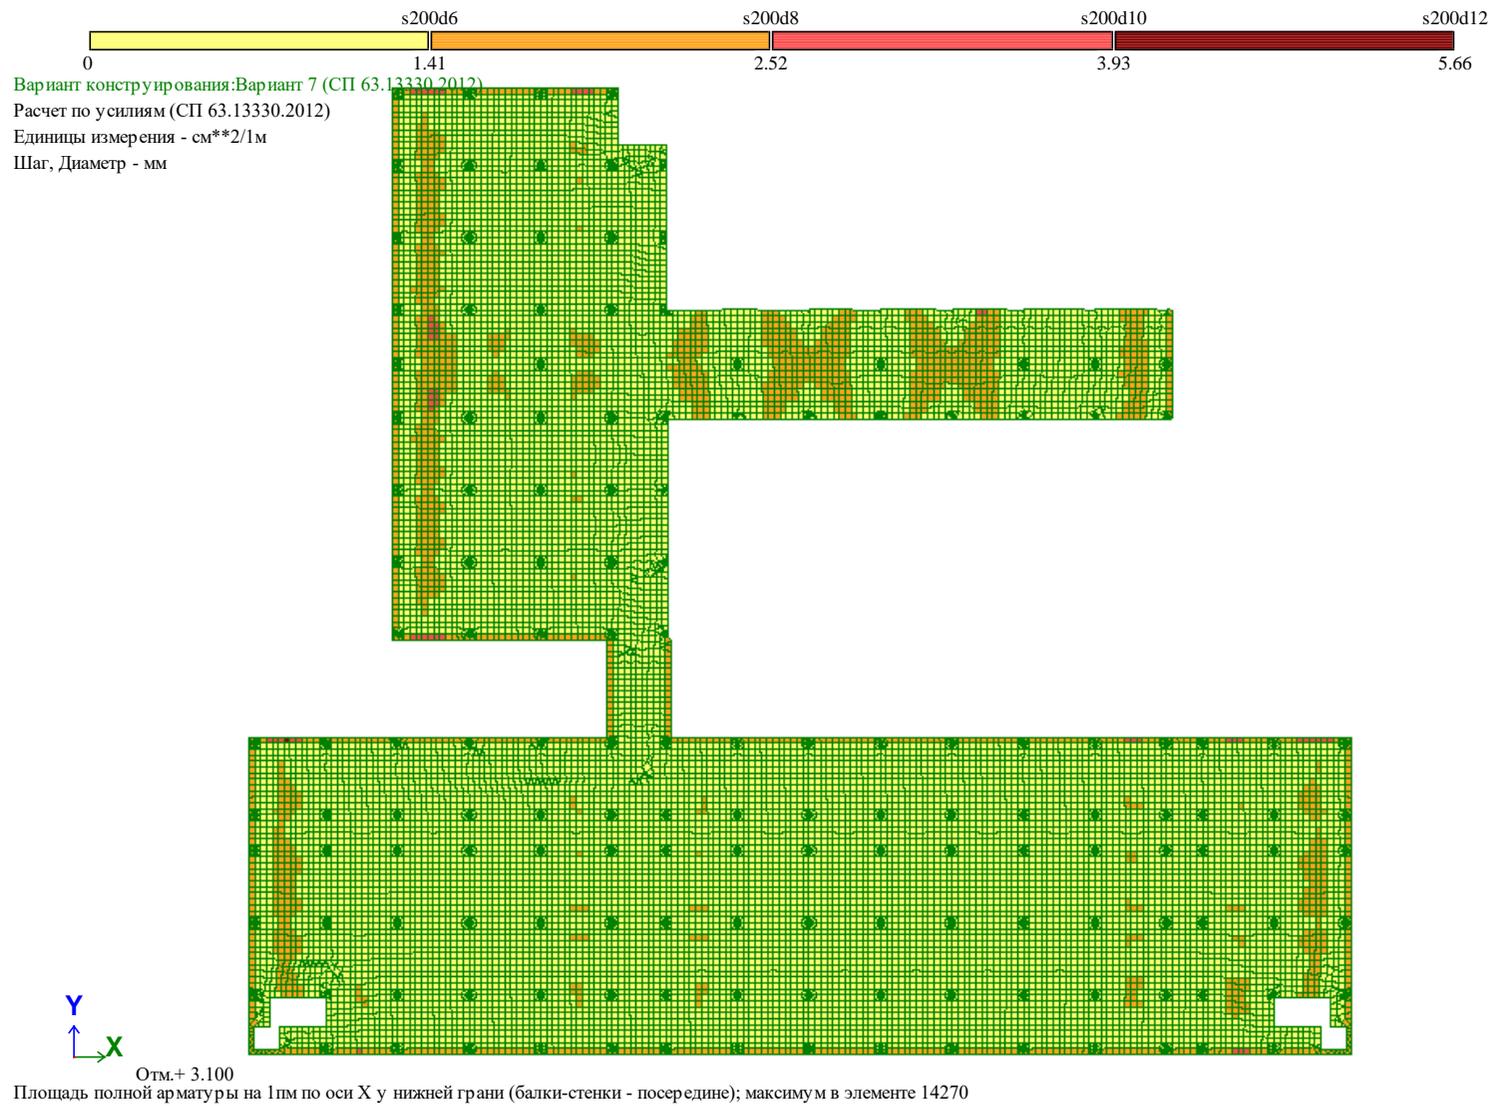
Мозаика нижнего армирования плиты перекрытия по оси X₁
